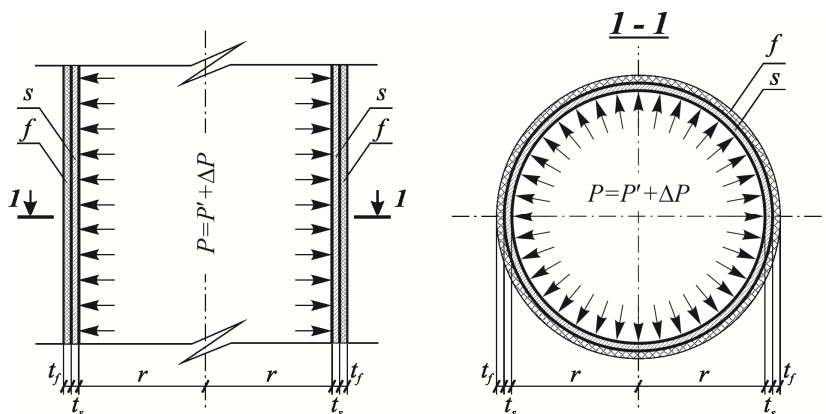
Расчетная схема стальной цилиндрической оболочки резервуара, усиленной внешним поперечным фибропластиковым армированием: s — стальная оболочка резервуара, f — слой внешнего поперечного фибропластикового усиления
